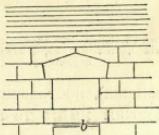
Перекрытие оконныхъ отверстій въ цо-
